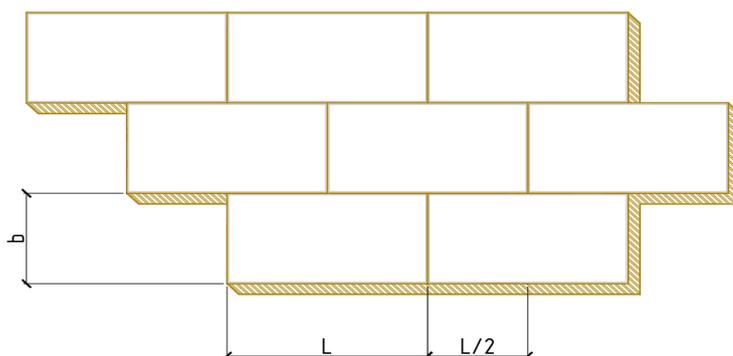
Смещение плит нижнего слоя теплоизоляции при укладке
